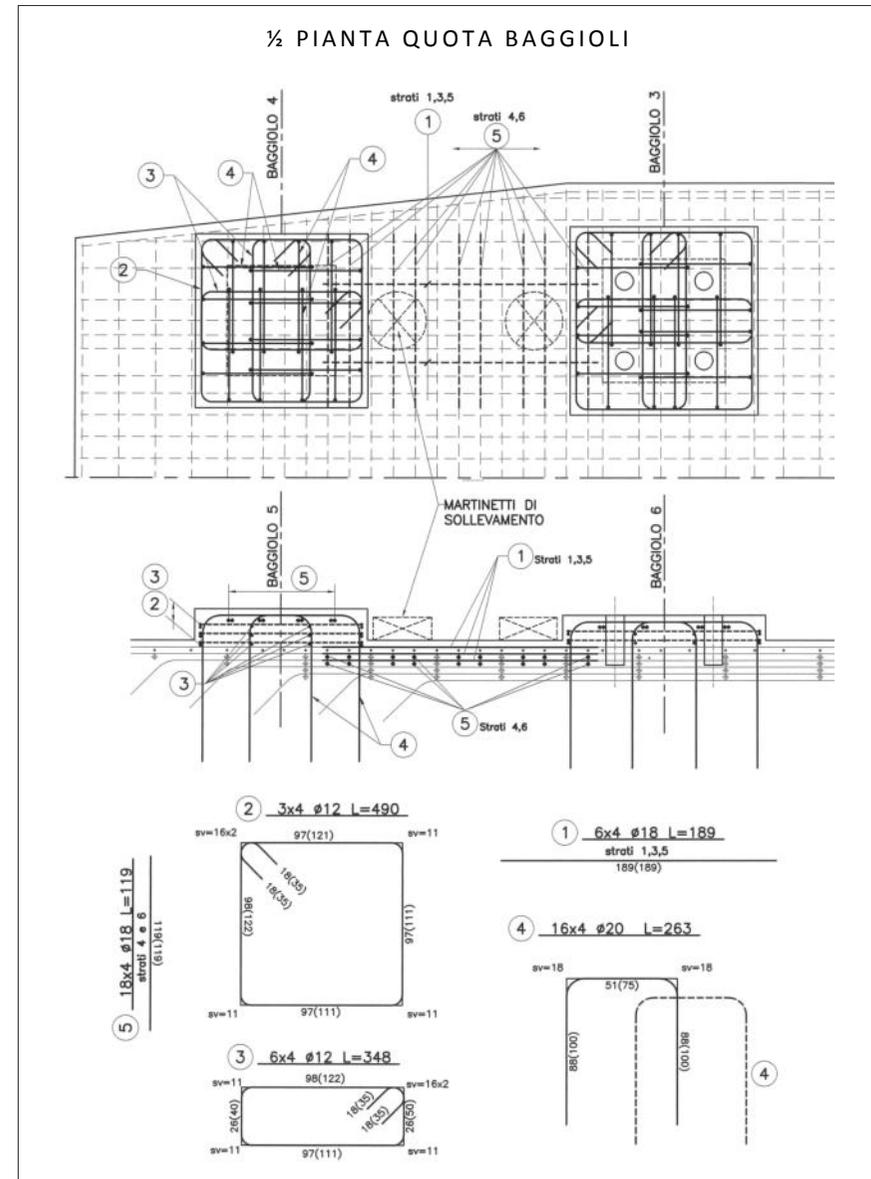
Esempio di armatura costruttiva dei baggioli e frettaggio dei punti di sollevamento
